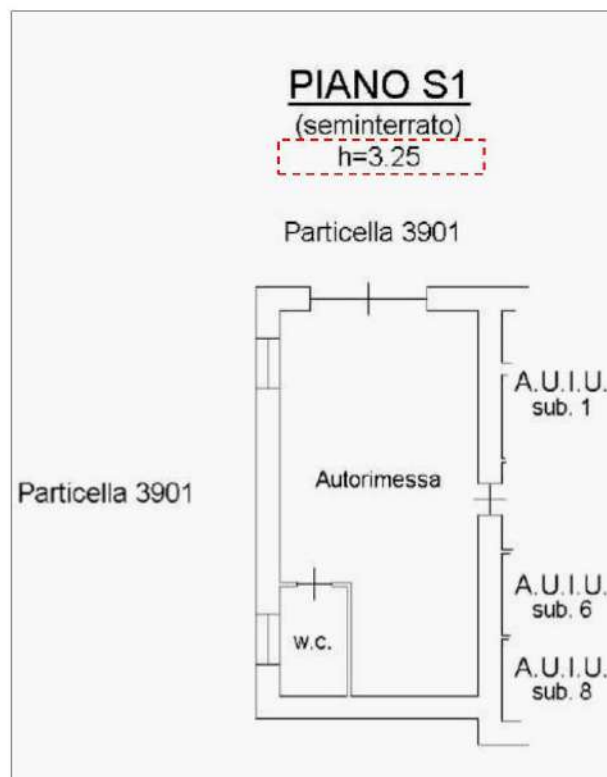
Planimetria castale autorimessa comune (Sub. 2)
